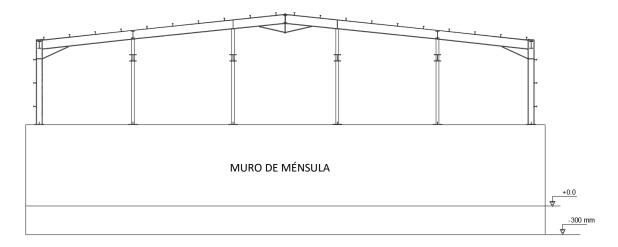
Pilares pórtico posterior apoyados muro ménsula. Fuente: Elaboración propia.
